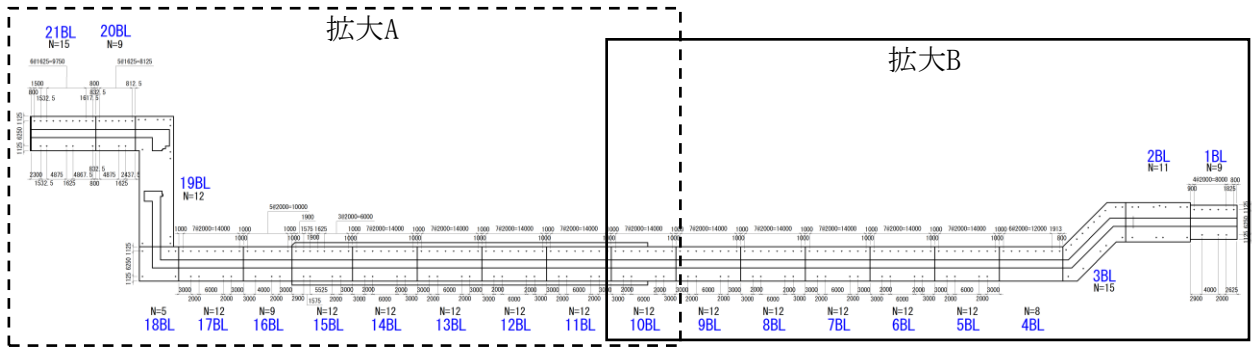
(1) 防波壁（逆T擁壁）のグラウンドアンカ配置図（全体平面図）
